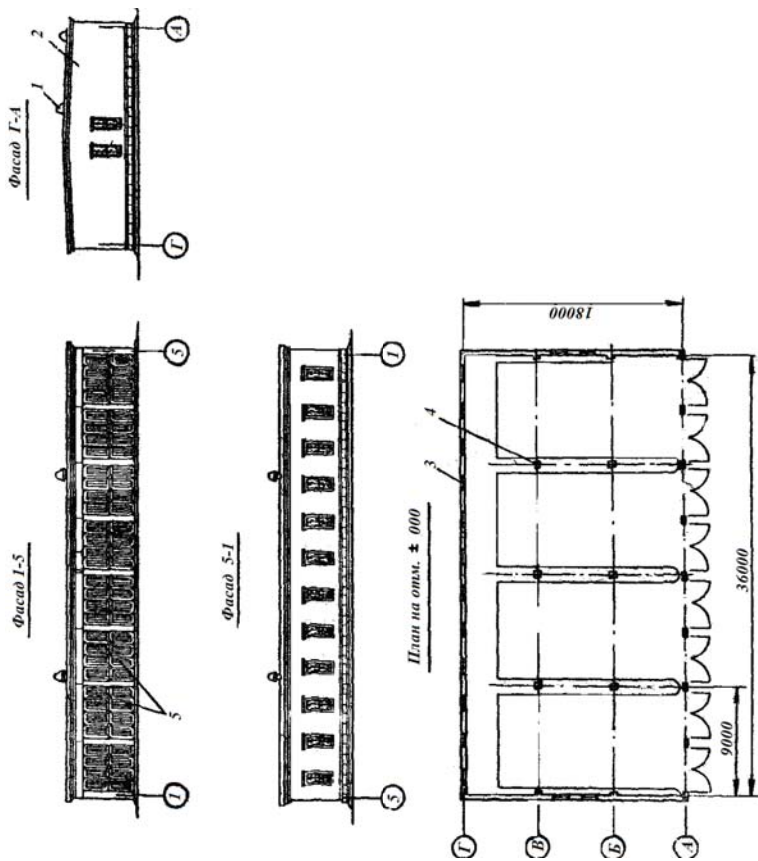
План и фасады неотпливаемого хранилища на 16 машин:
